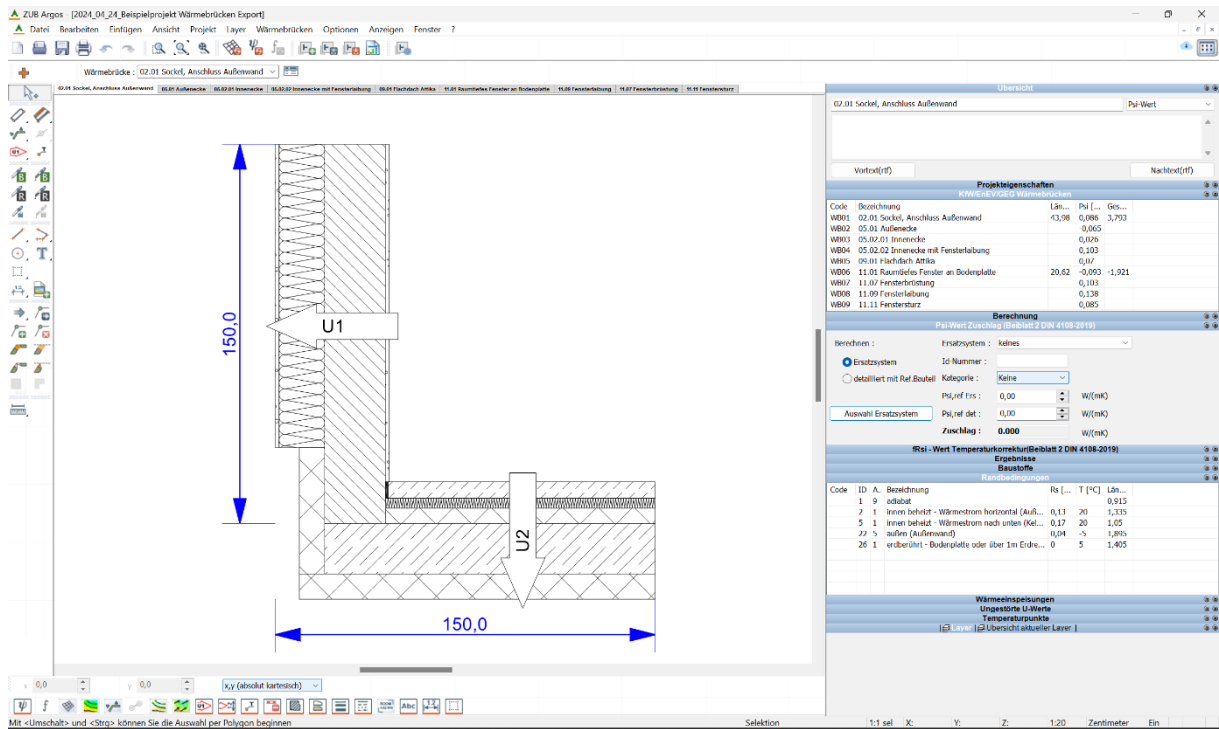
Pro: Wärmebrücken-Detail: Sockel, Anschluss Außenwand
